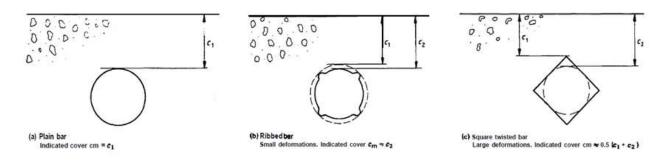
Possibili errori di misura nel caso di barre con sezione trasversale diversa da un cerchio.
